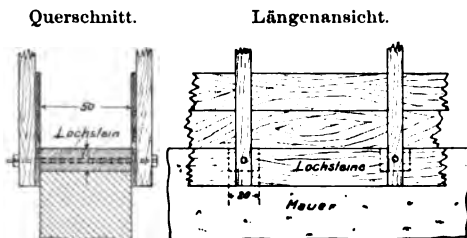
Verschalung einer Mauer mit Hilfe der „Lochsteine“.
